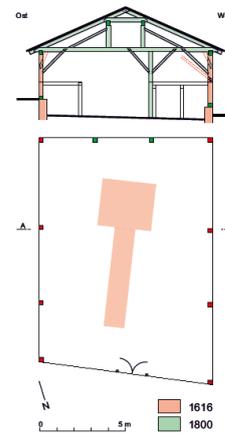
Grundriss und Querschnitt 1:200.
